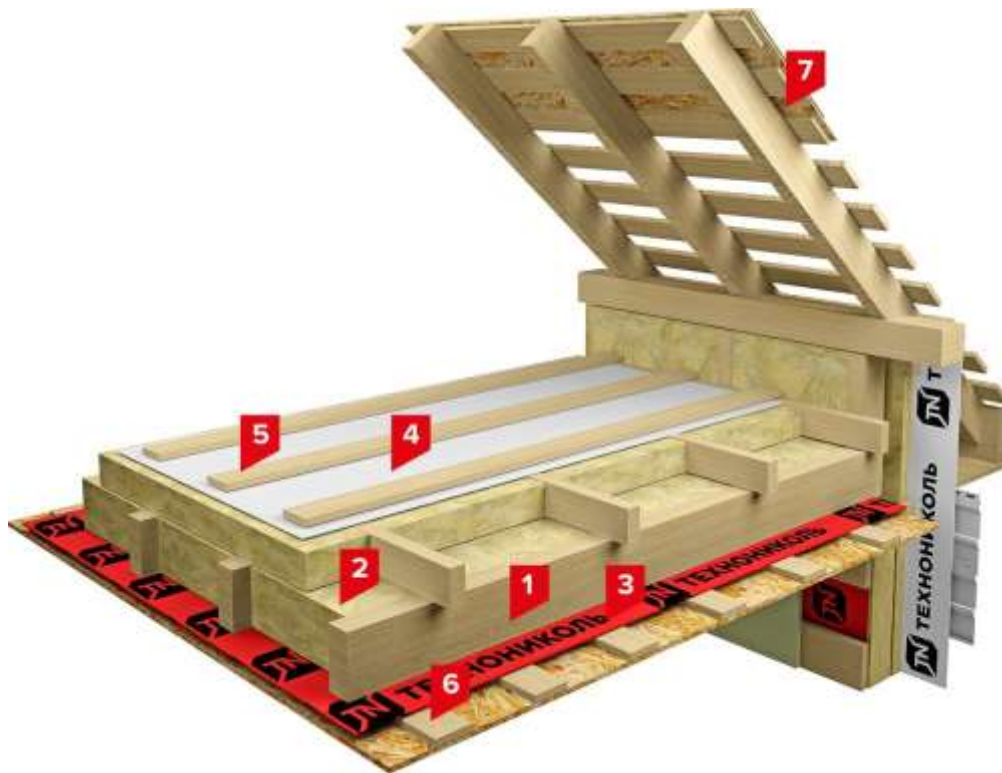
Конструктивне рішення горіщного утепленого перекриття по дерев'яних балках: 1 – балки перекриття; 2 – плити з кам'яної вати; 3 – пароізоляційна плівка; 4 – плівка вітро-, гідрозахисна; 5 – чорнові лати; 6 – покриття підлоги
